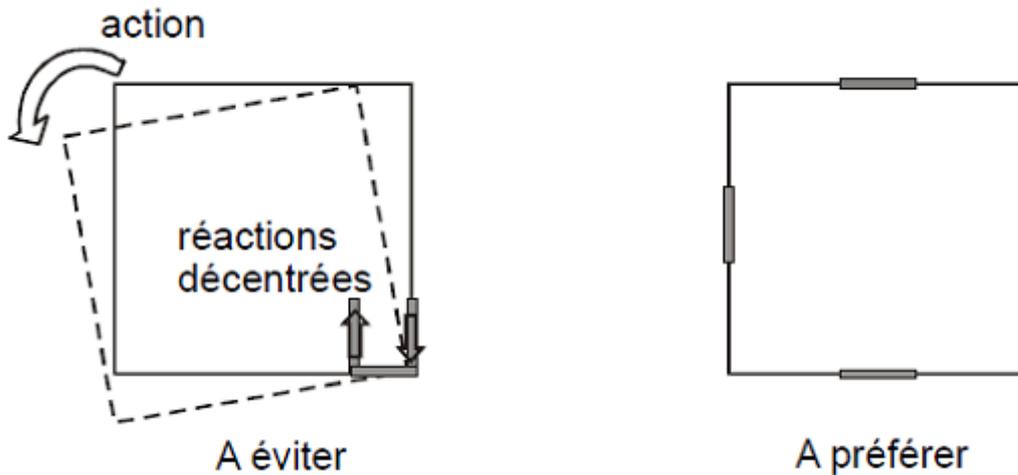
Impact du positionnement des éléments rigides sur la torsion dans le bâtiment.
